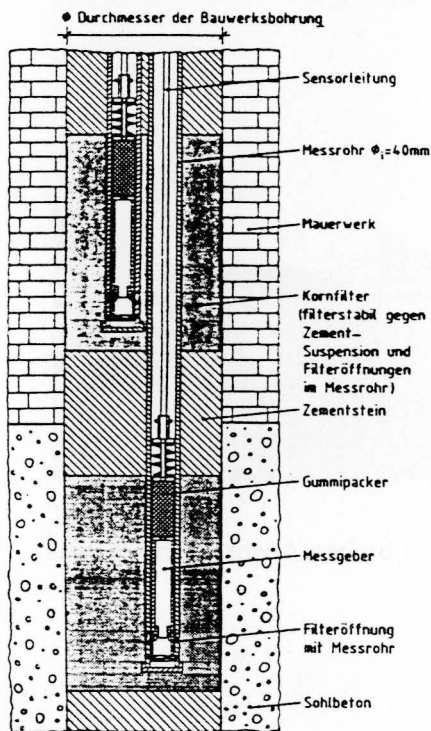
Schnittzeichnung durch das Mauerwerk und den Sohlbeton mit Angabe der Meßbedingungen (Packertyp 1 und 2)
